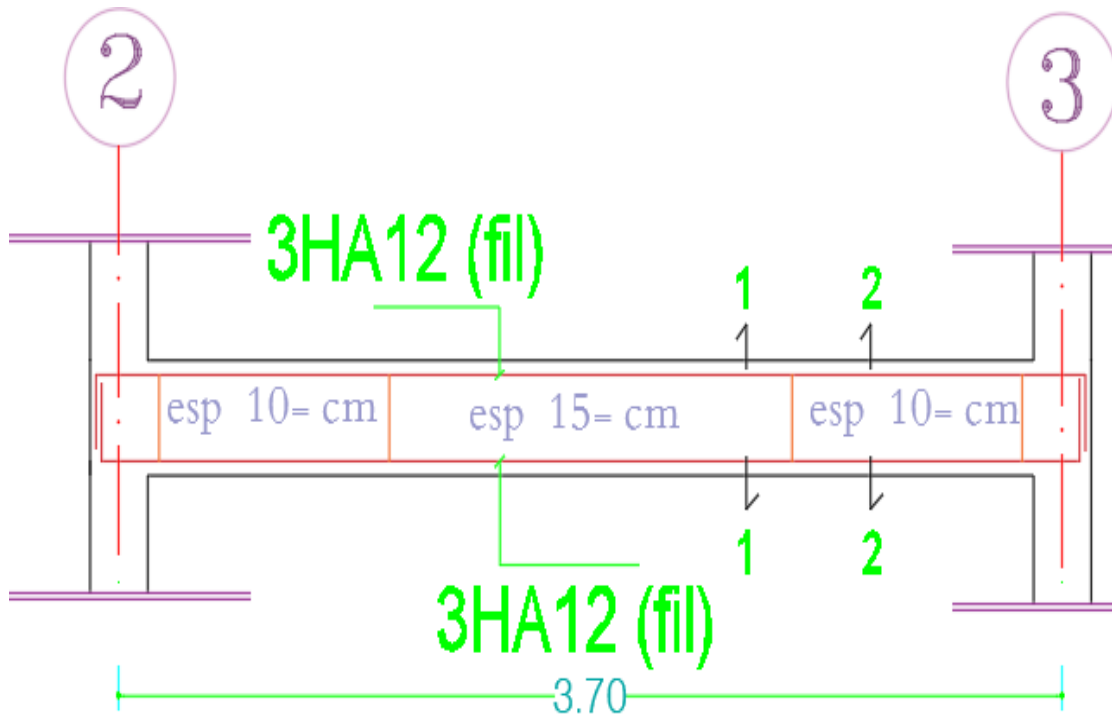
Schéma de ferrailage de la poutre de chaînage.
